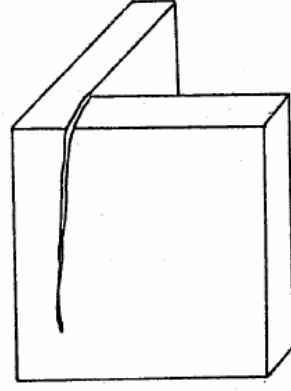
İki taraflı hasır çelik ve püskürtme beton uygulaması [32].
